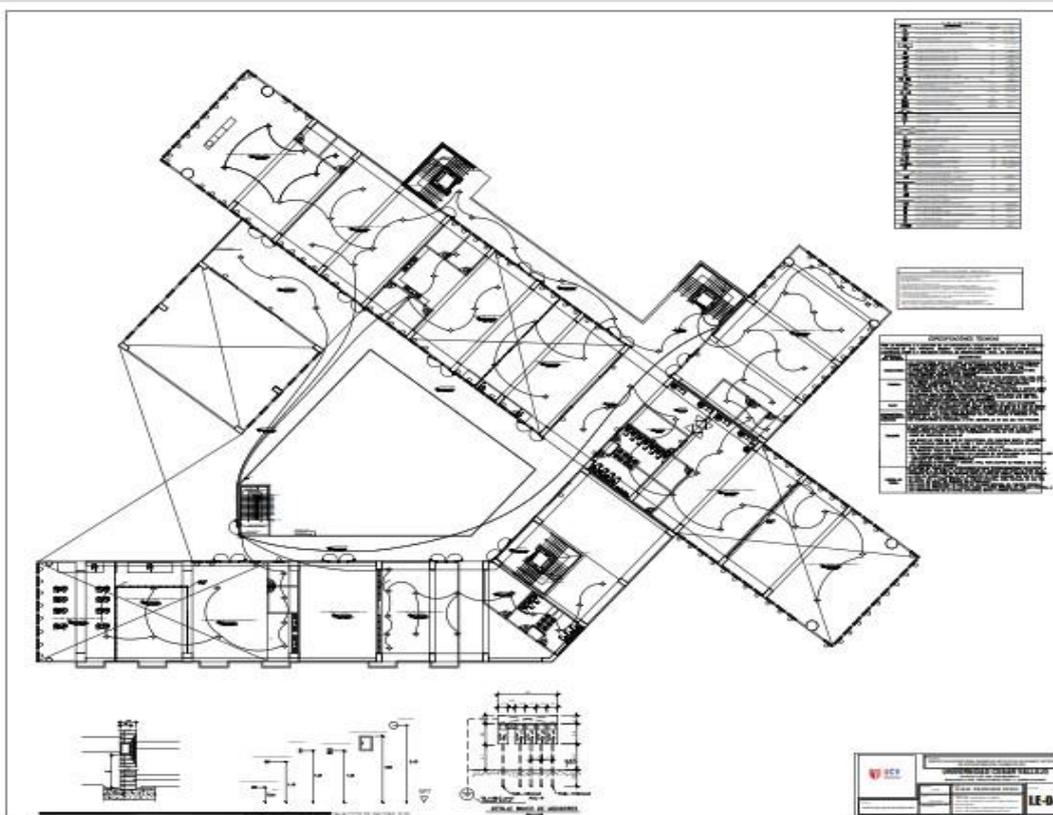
Plano de Instalaciones Eléctricas 3 nivel. Fuente: Elaboración Propia
